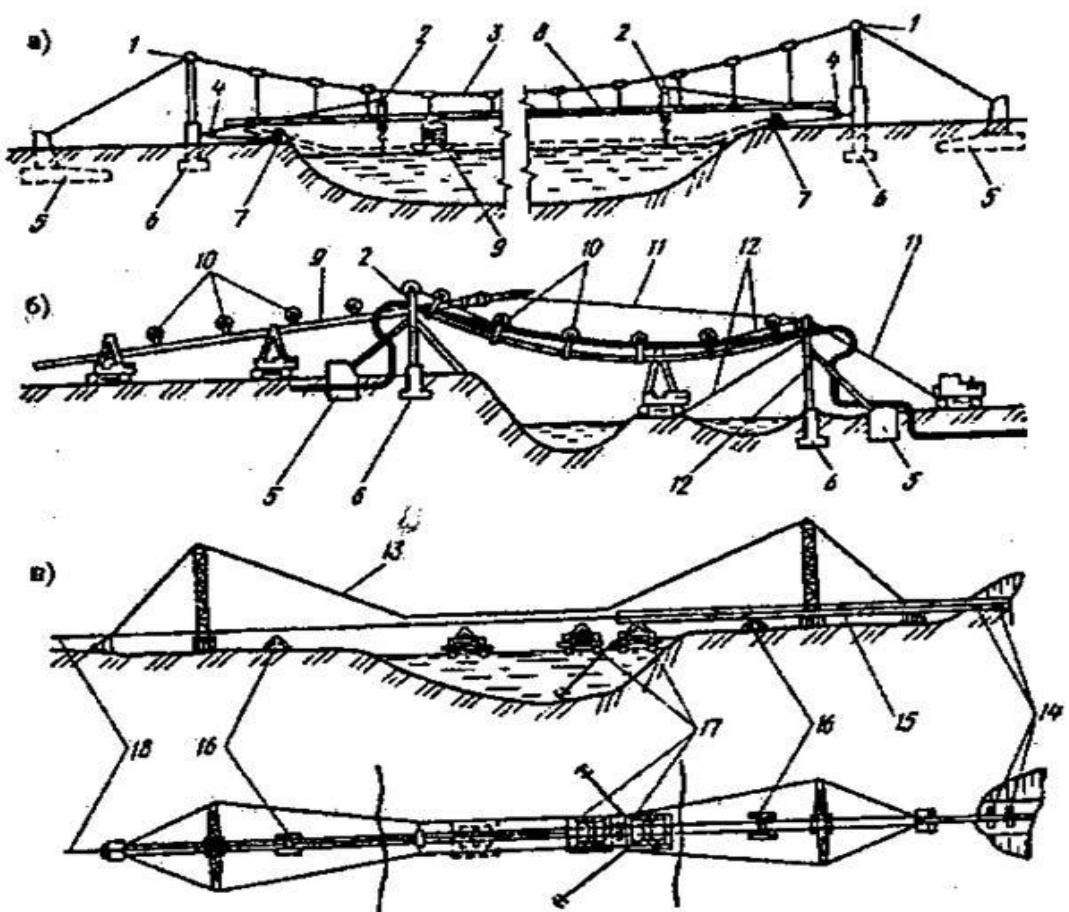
Монтаж подвесных и висячих трубопроводов
